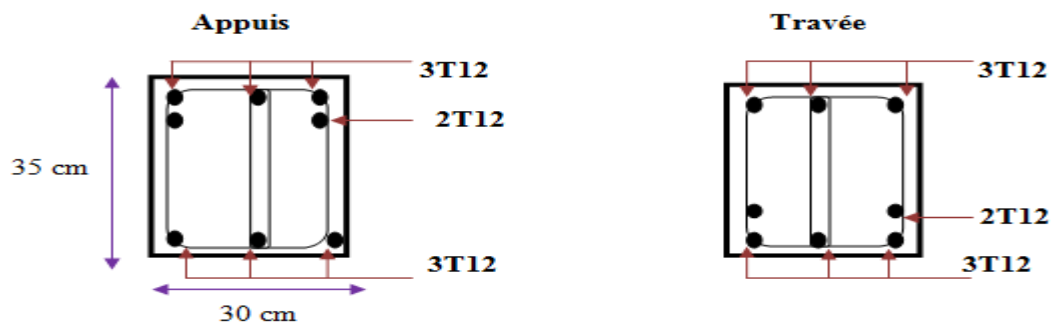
Schémas de ferrailage des poutres secondaire (30×35)
